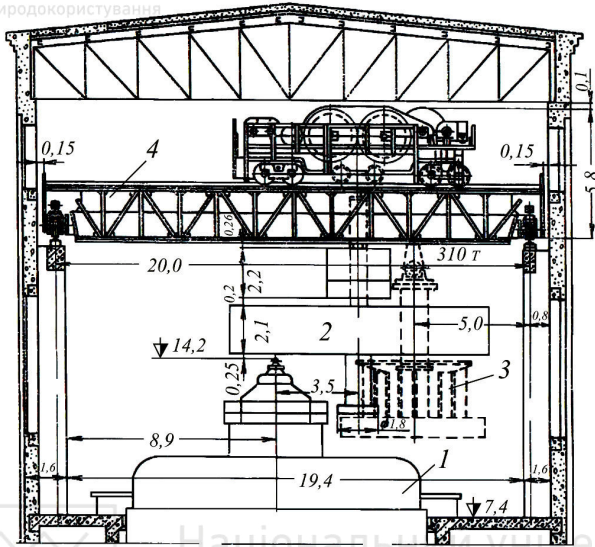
Схема підйому обладнання краном будівлі ГЕС:
